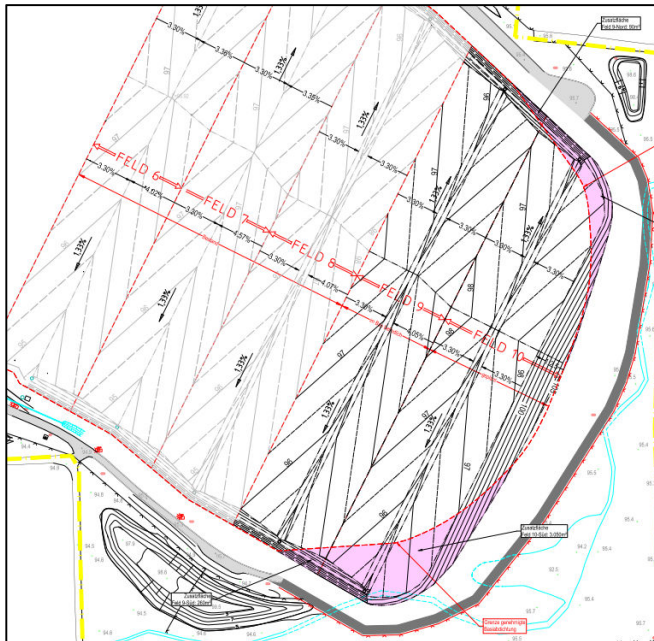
Optimierter Grundriss Basisabdichtung Felder 9+10 und Umbau Deponieumfahrung (Auszug aus Anlage 1.1)
